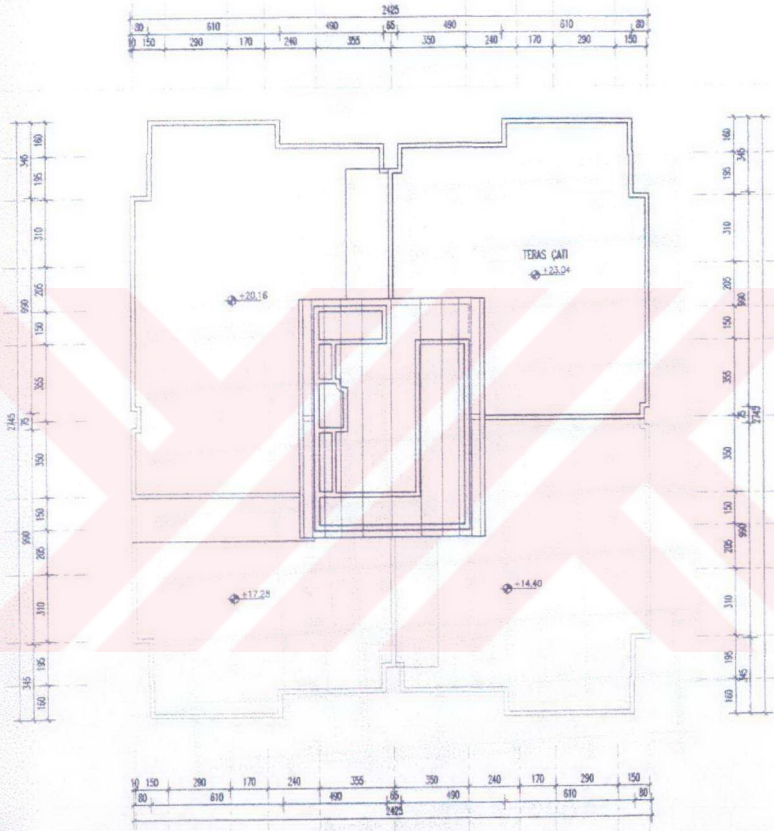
Çağdaşkent toplu konut projesi 6.kat planı
